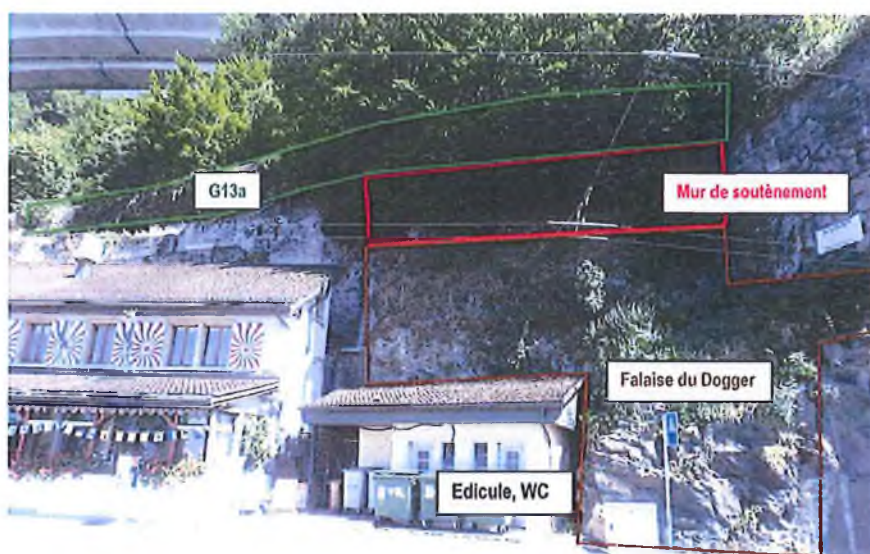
Vue vers l'Est, zone brune : calcaires du Dogger, zone rouge mur : de soutènement, zone verte : ouvrage parre-pierres G13a.
